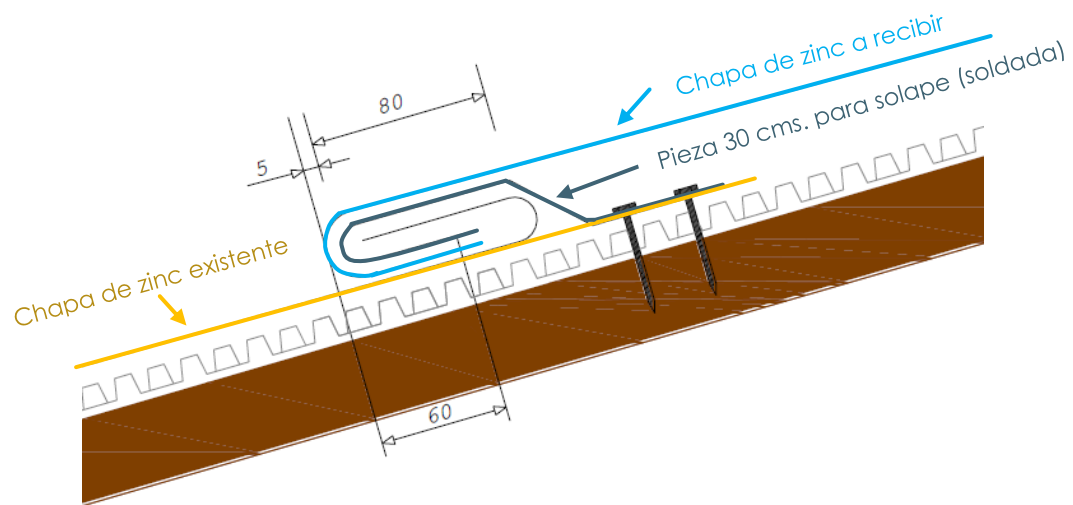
Detalle solape chapas zinc. Fuente: Elaboración propia.
